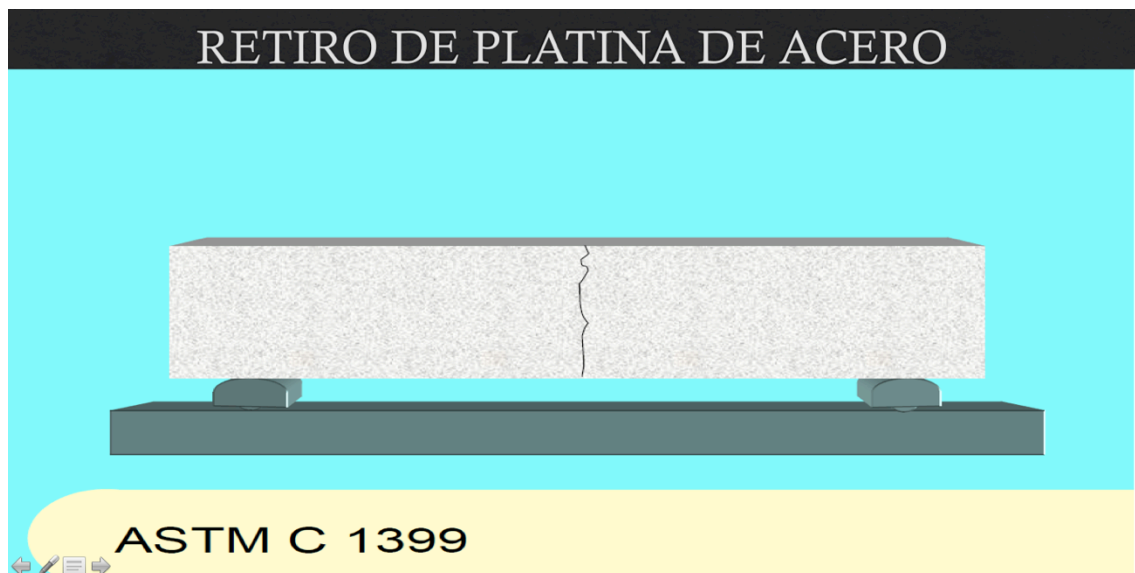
Esquema de retirado de platina bajo viga de concreto.<sup>49</sup>
